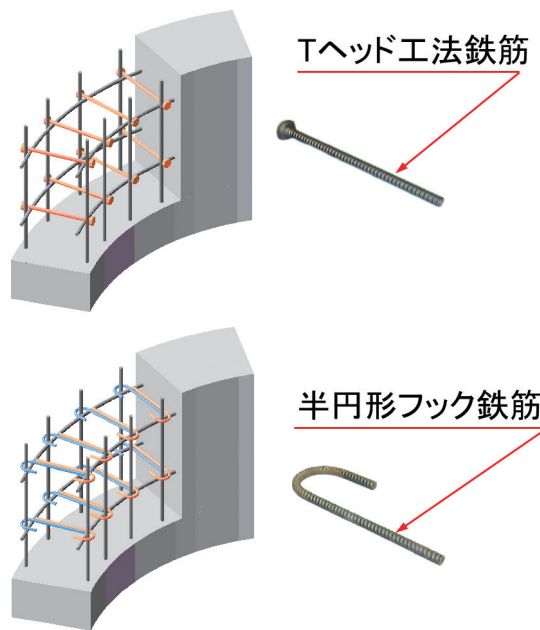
「Tヘッド工法鉄筋」と半円形フック鉄筋の施工方法
